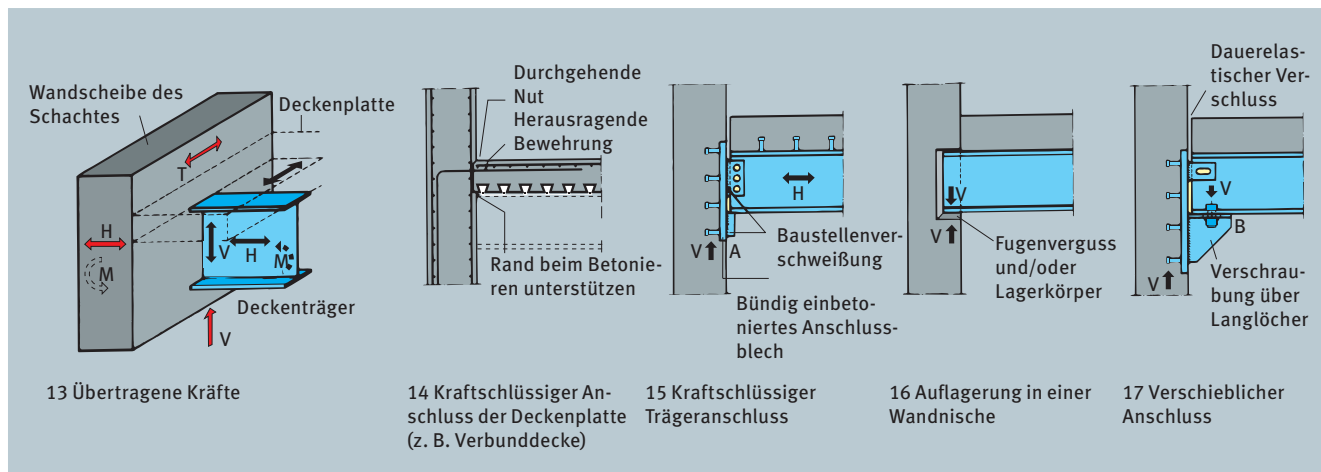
Schächte im Geschossbau - Anschluss an Geschossdecken
